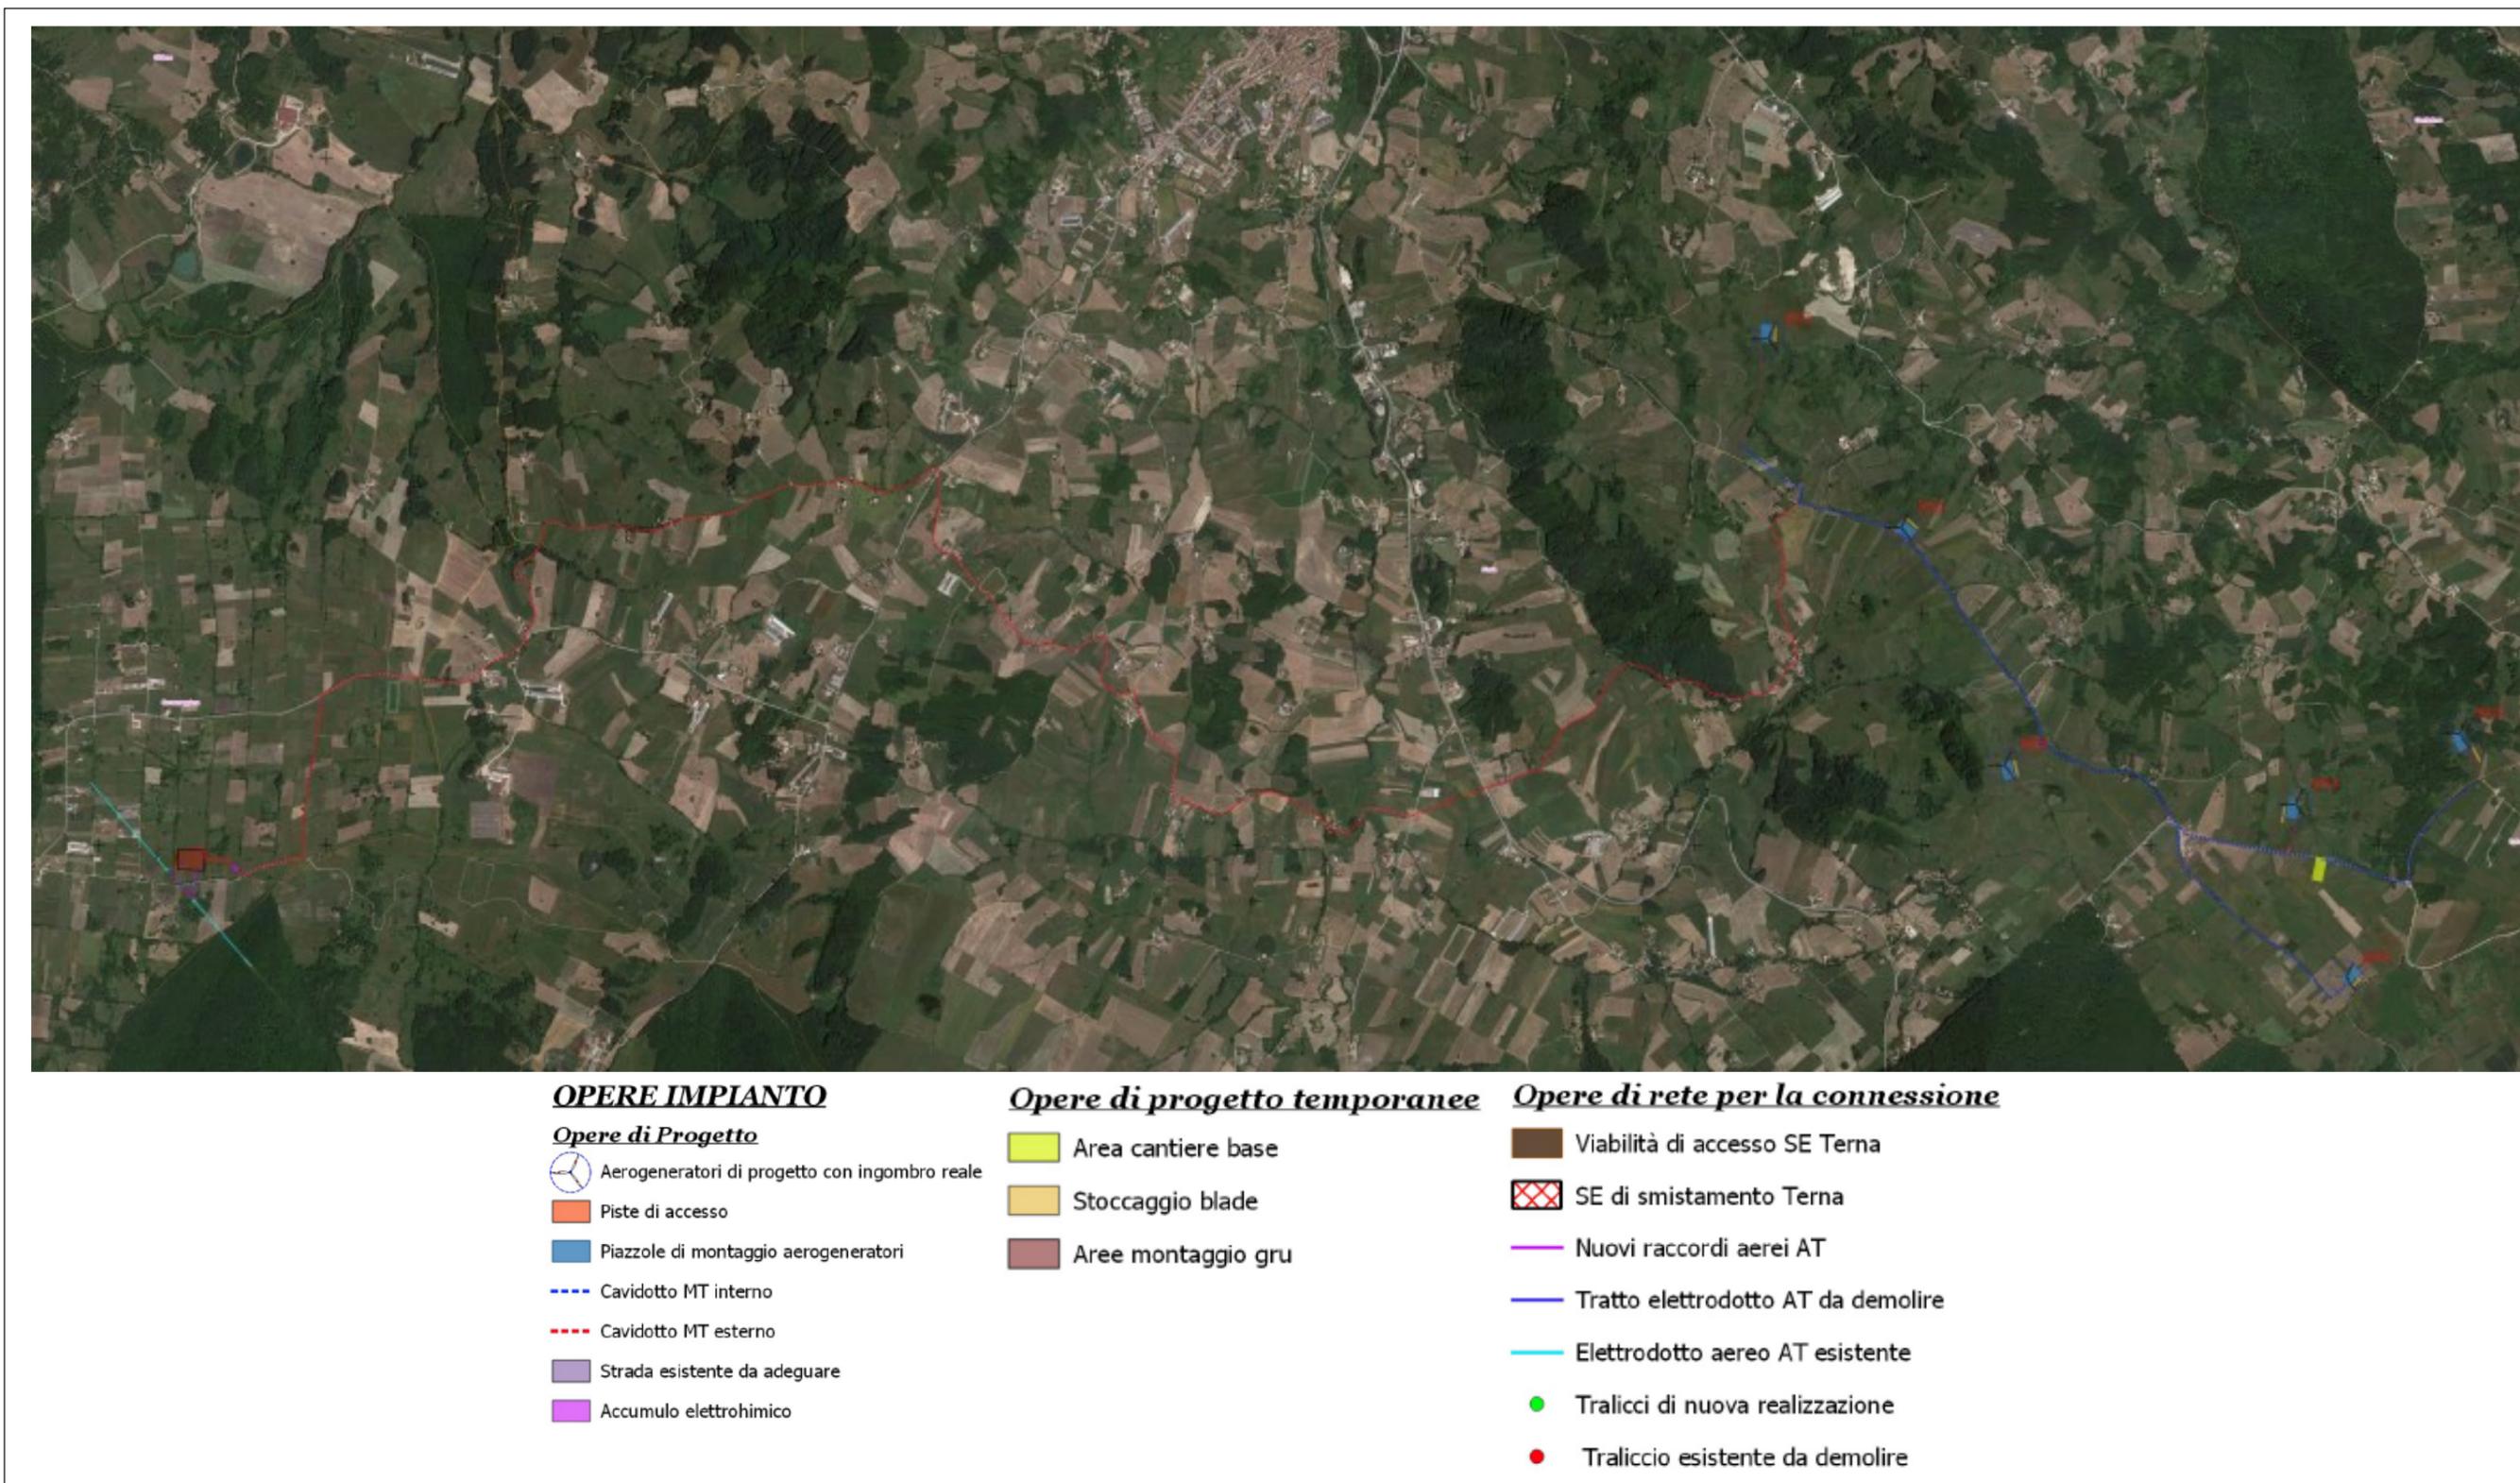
Inquadramento opere di progetto su ortofoto, stralcio TAV RIC_ORTO.01
